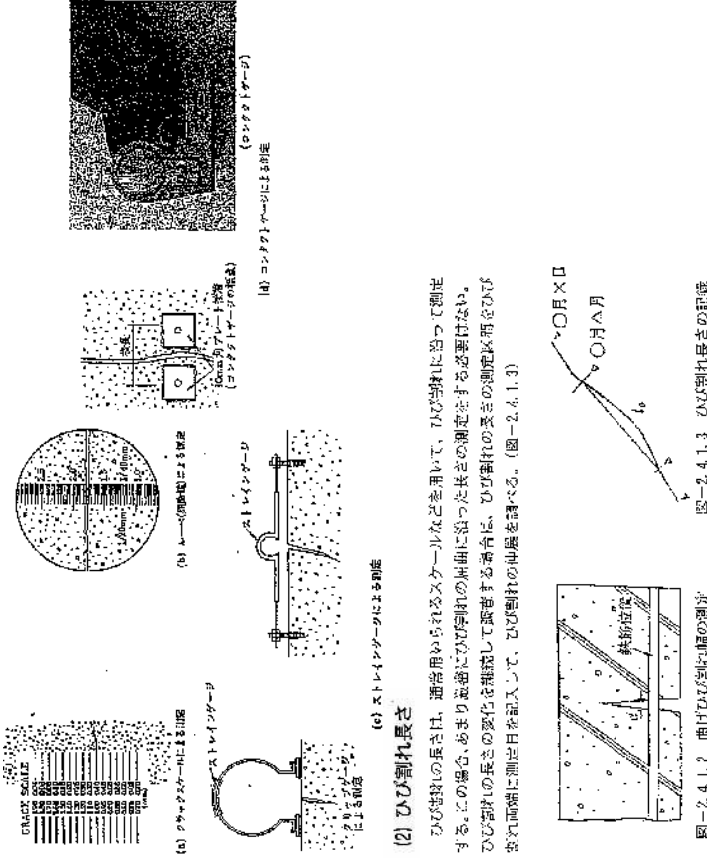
曲げひび割れ幅の測定
